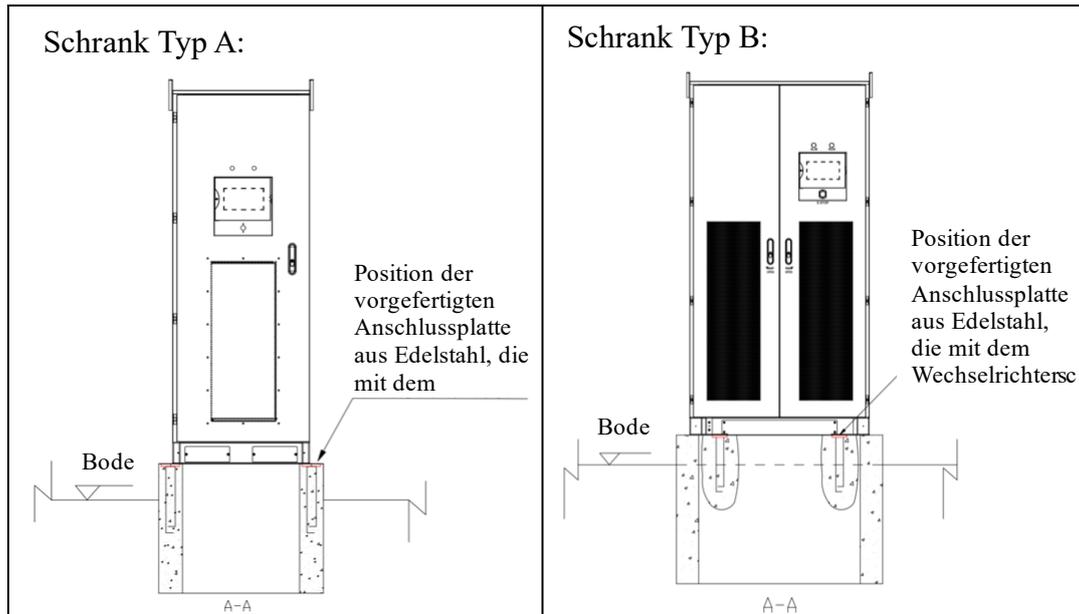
Schweißdiagramm des Wechselrichterschrankes und des voreingebetteten Stahls
